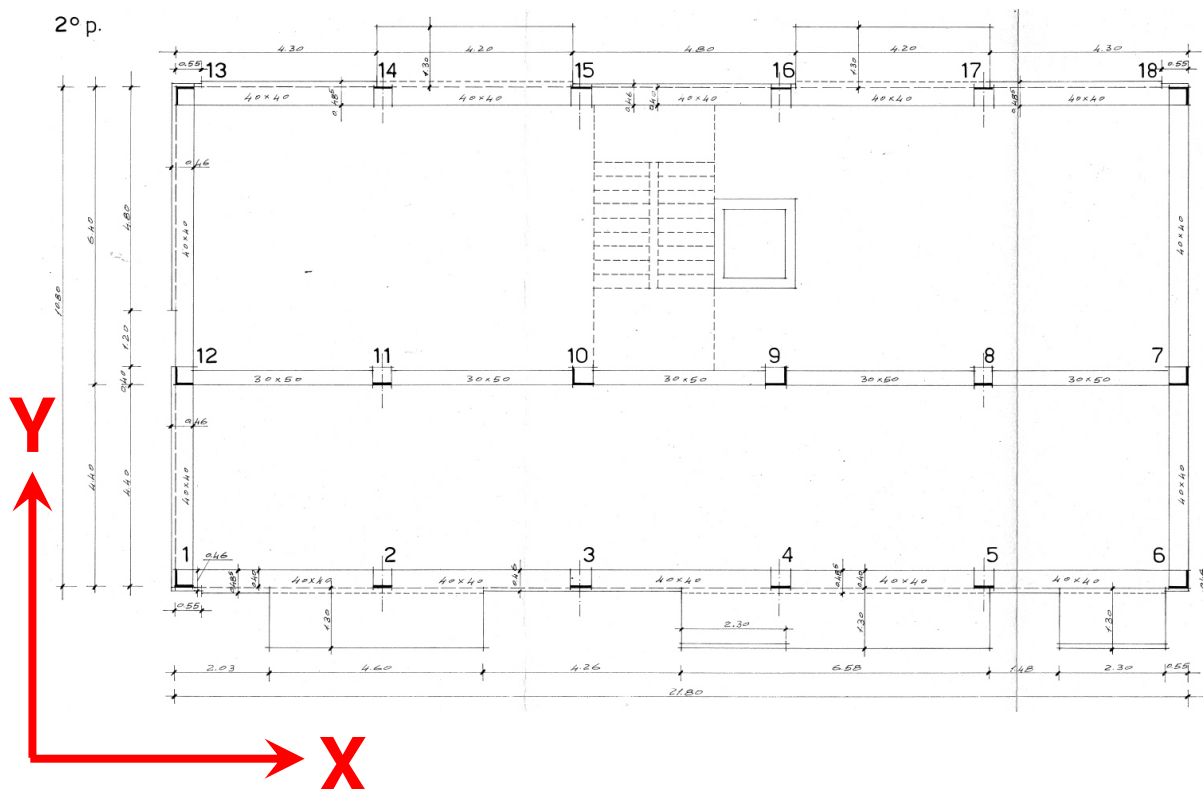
Lotto n.351 – Pianta strutturale originale delle travi e dei pilastri e assi di riferimento.
